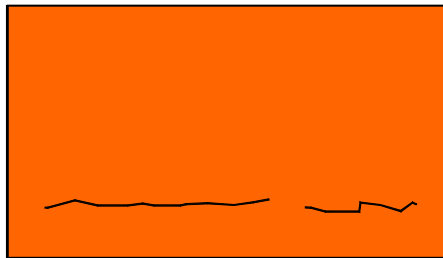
Fissuras horizontais na alvenaria provenientes da actuação excessiva de cargas [30]
